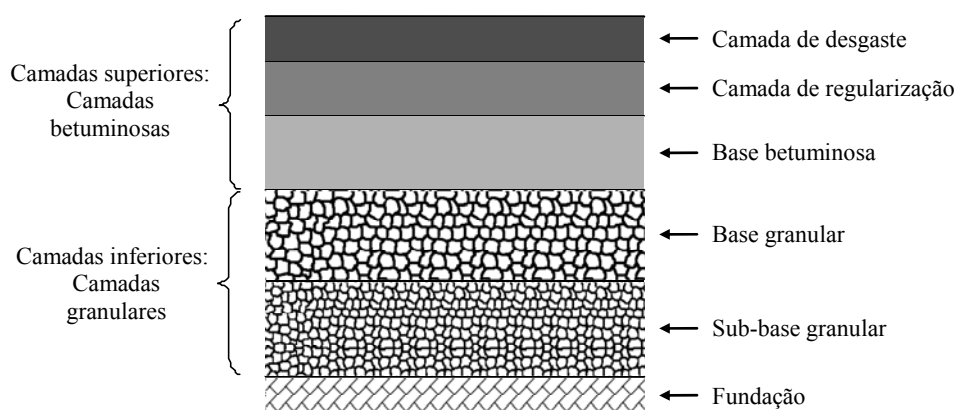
Constituição tipo dum pavimento rodoviário flexível
